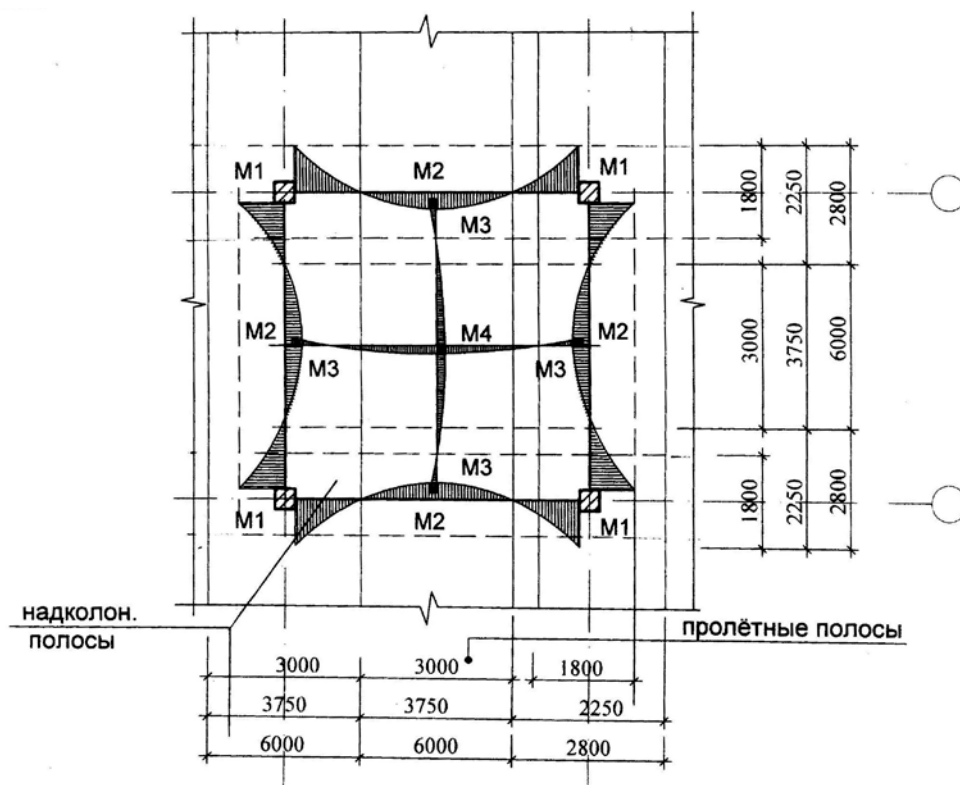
Эпюры моментов для фундаментных плит и плит перекрытия
